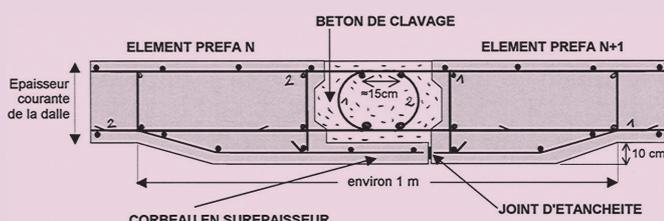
Clavage par corbeaux en béton en surépaisseur
